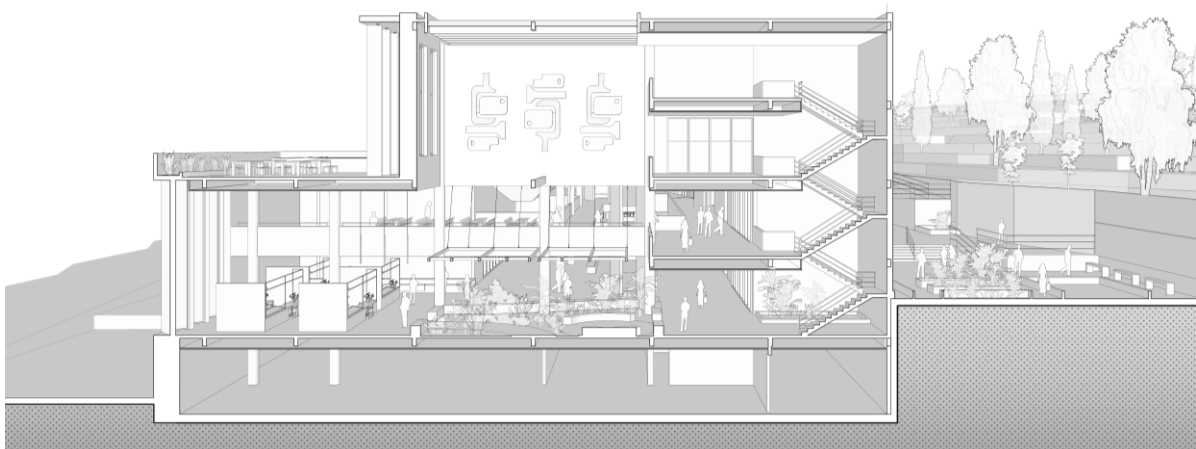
Corte longitudinal del proyecto. Elaboración Propia
